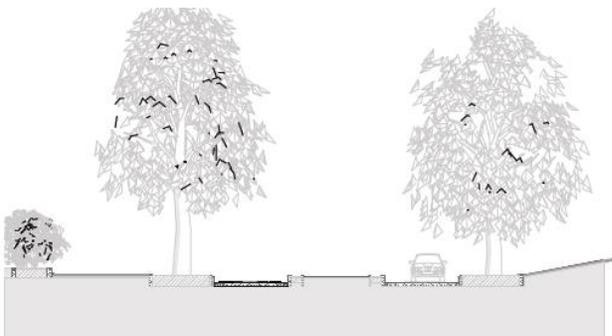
Perfil urbano donde se evidencia la propuesta vial para la carrera.
